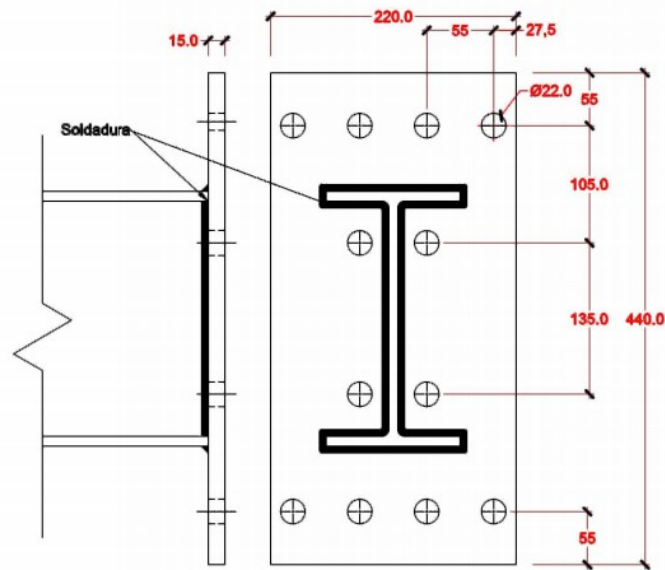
Desenho da placa de fixação soldada a extremidade da viga.
